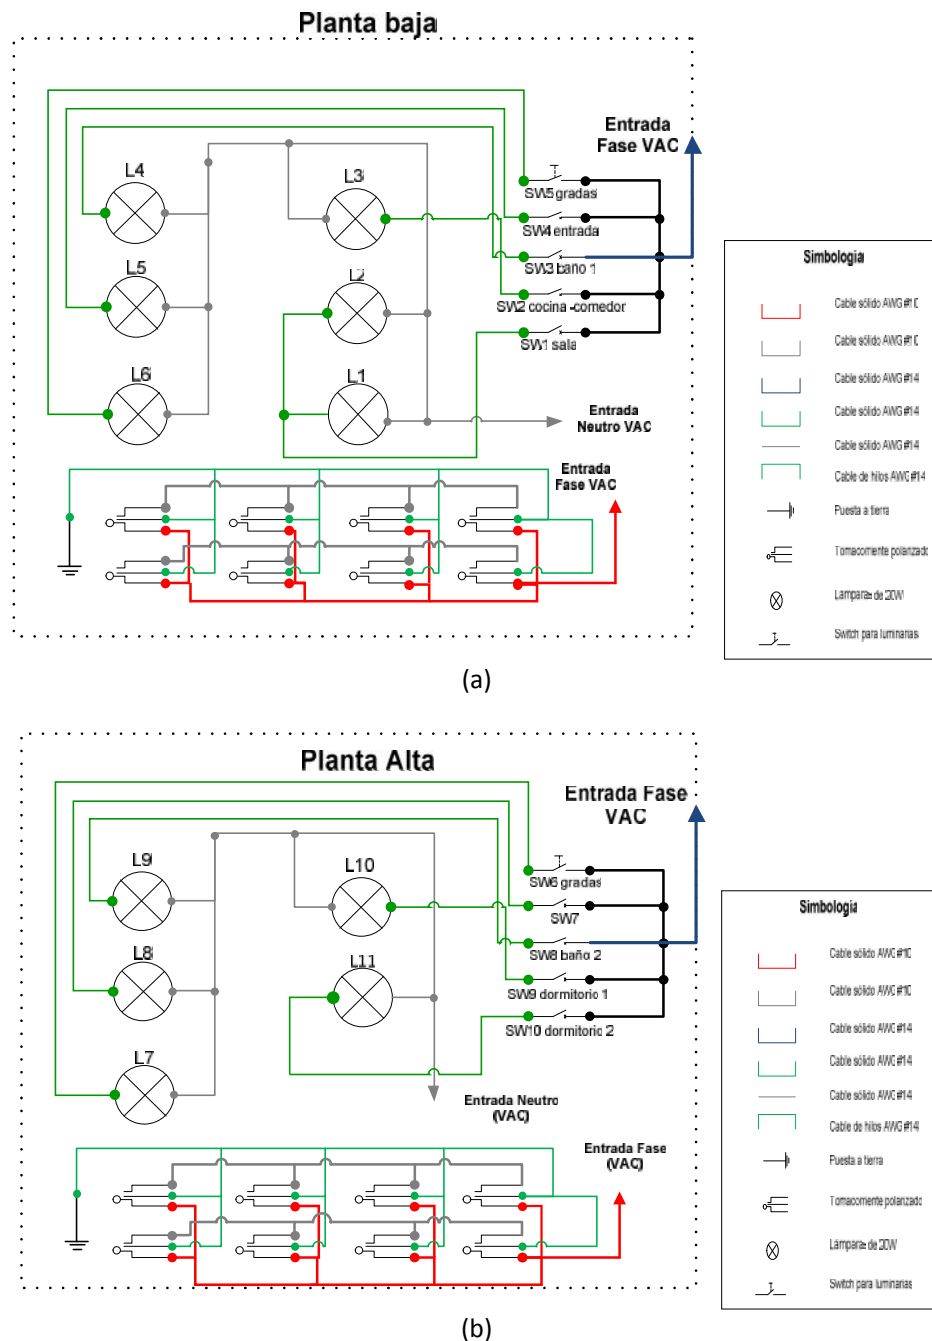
Esquema de conexiones del módulo de iluminación a) planta baja y b) planta alta de la vivienda.
